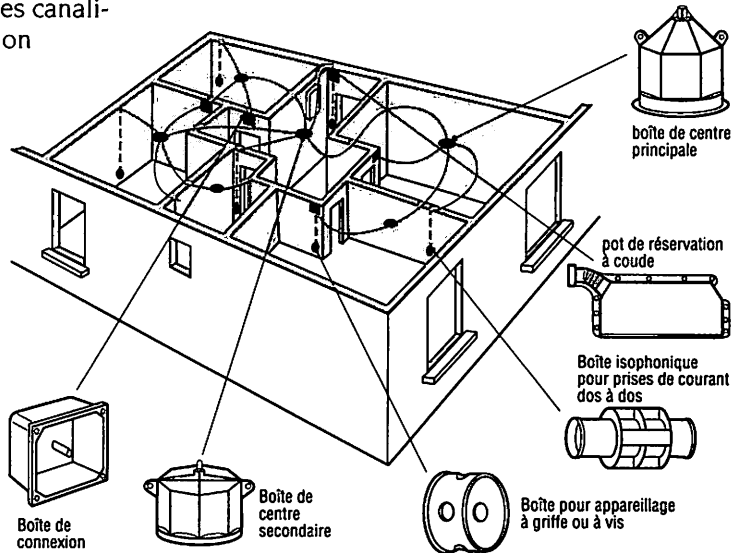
Exemple de disposition d'une installation en pieuvre.
